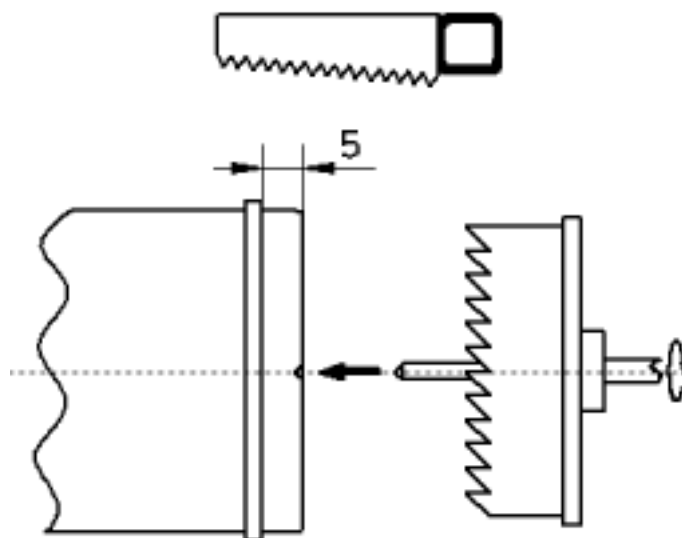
а Подготовка присоединительного штуцера сборного резервуара
